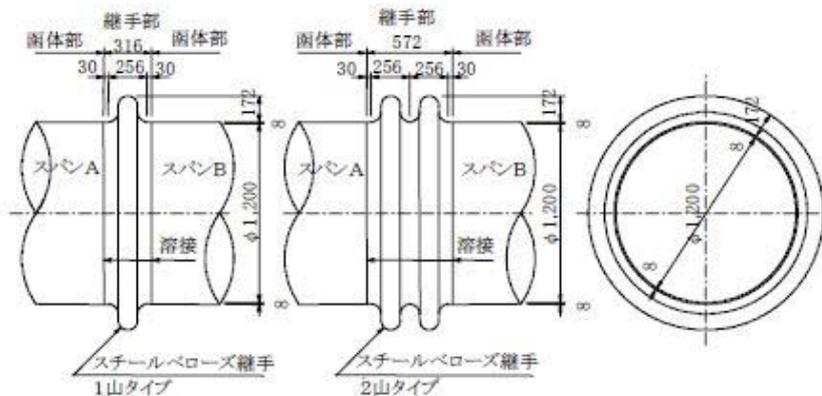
弾性継手の例 (スチールベローズ継手)
